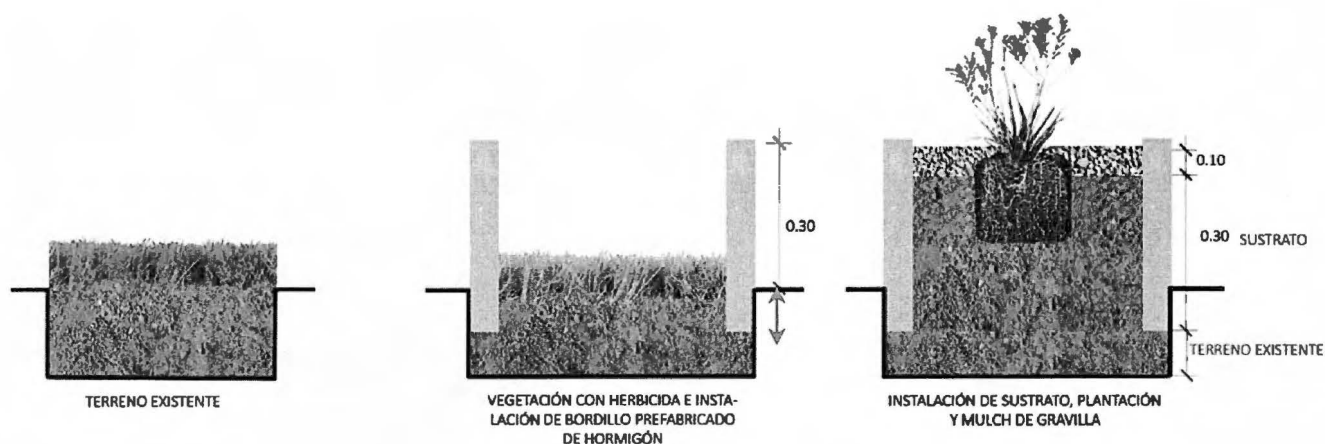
Modo de Plantación modelo escarpe superficial con levante de terreno de 10 y 30 cm.
